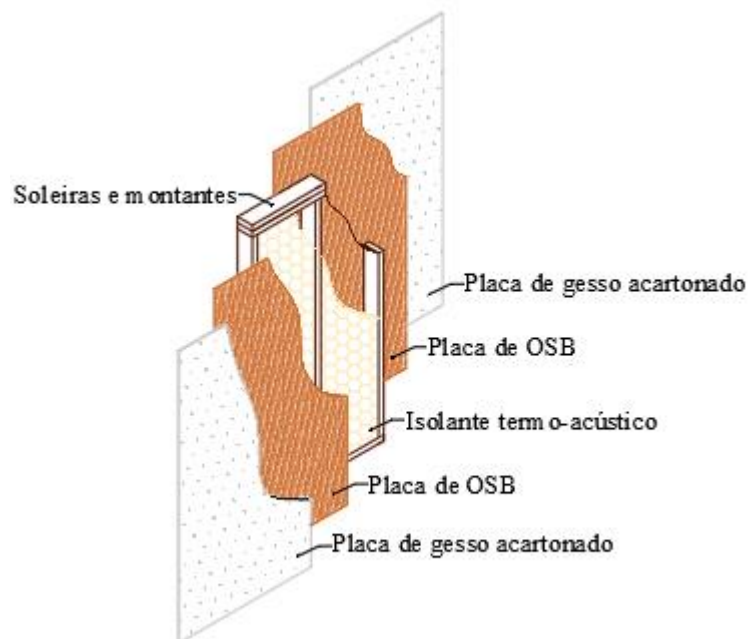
Composição das camadas que constituem a parede interna do sistema *Wood Frame*.
